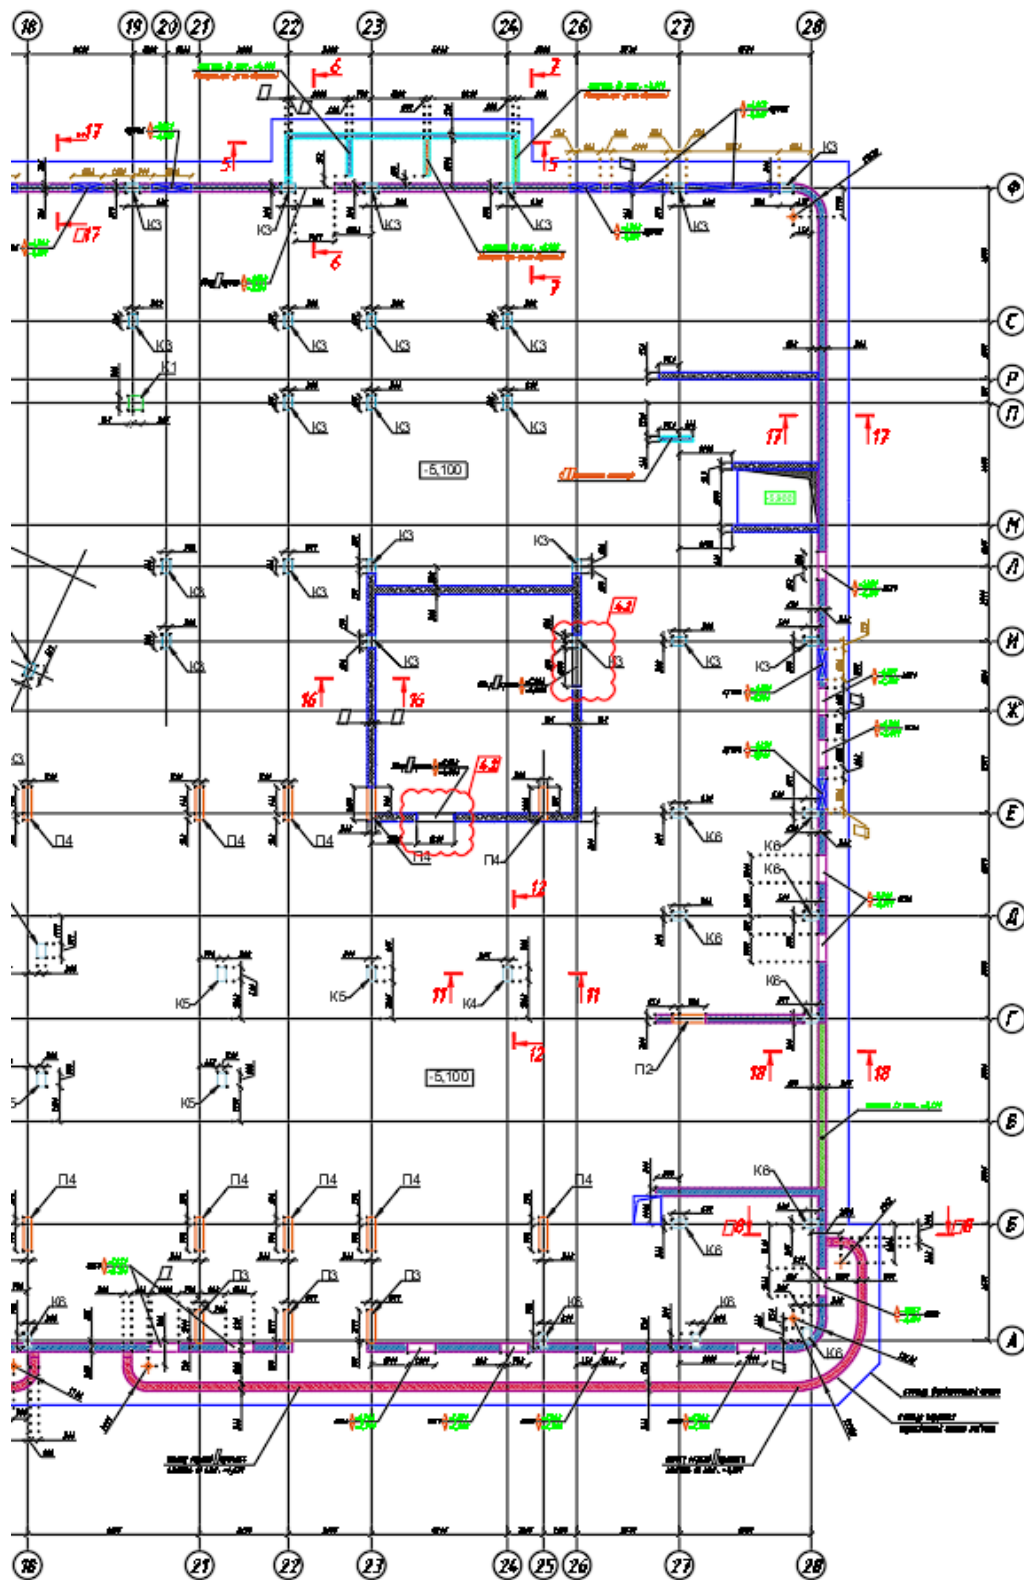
Схема расположения стен и колонн в осях 21-28. А-Ф
